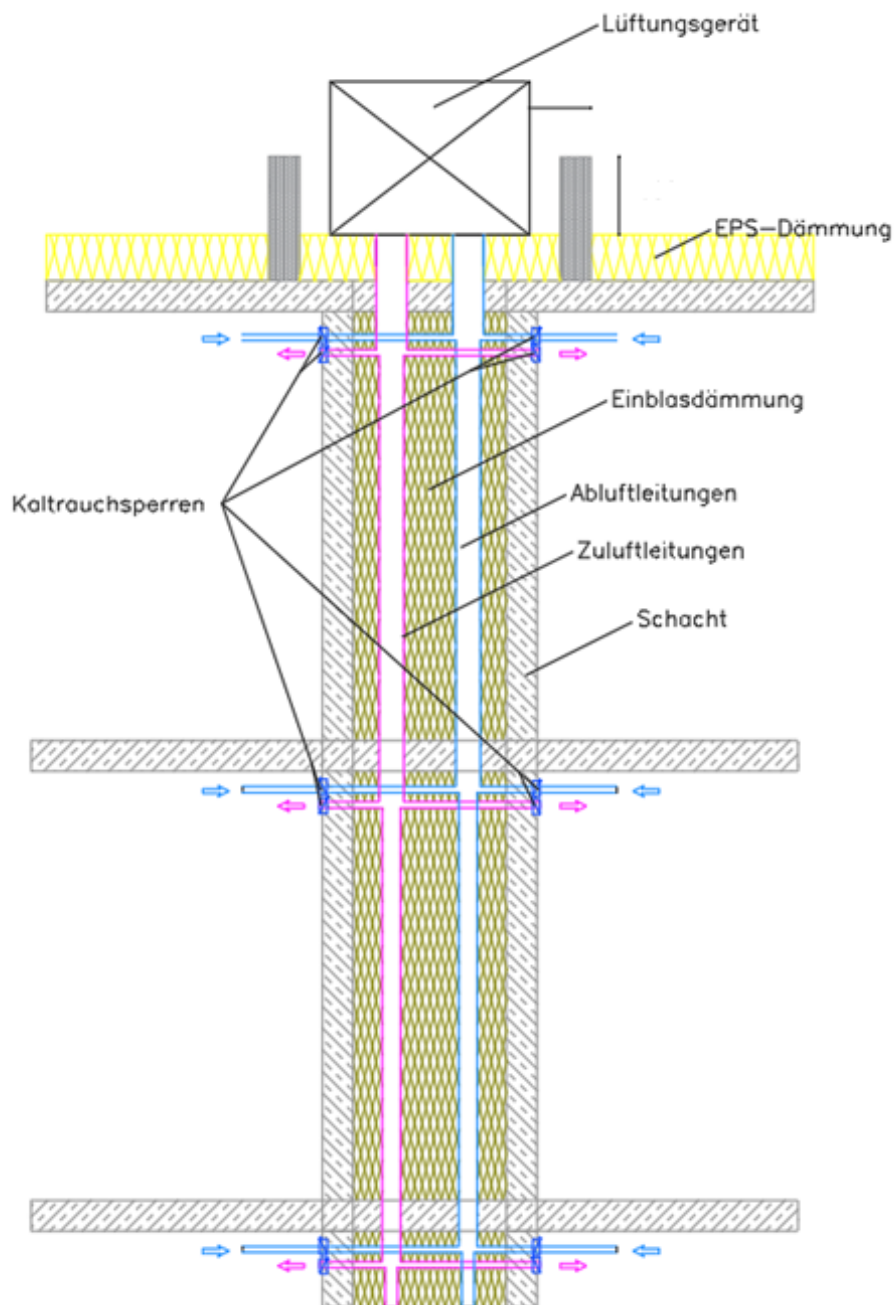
Variante 4 – Schacht mit Einblasdämmung, Dachaufstellung; Quelle: UIBK
